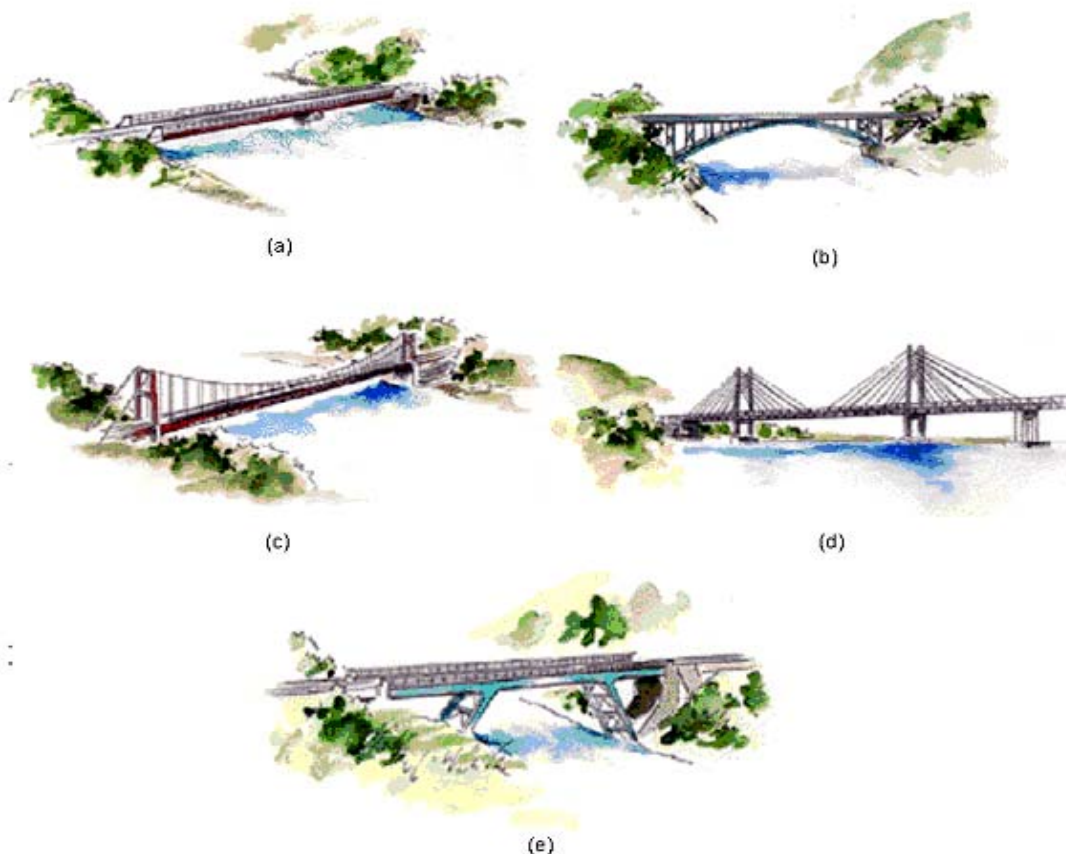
Sistemas estruturais adoptados em pontes e passarelas: (a) Ponte em Viga; (b) Ponte em Arco; (c) Ponte Suspensa; (d) Ponte de Tirantes e (e) Ponte em Pórtico.
